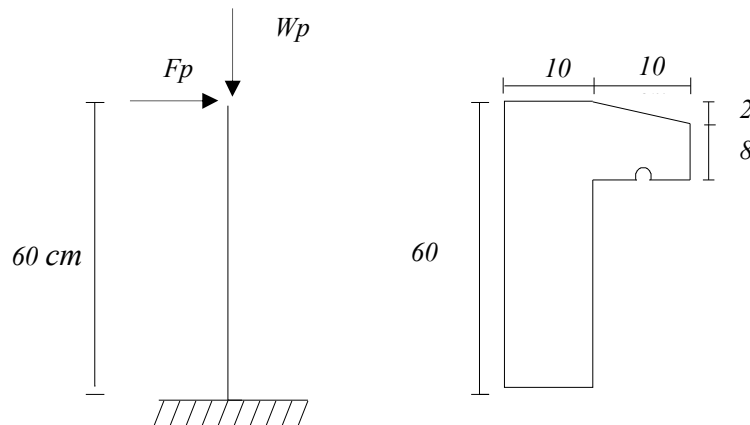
Schéma statique et dimensions de l'acrotère.
